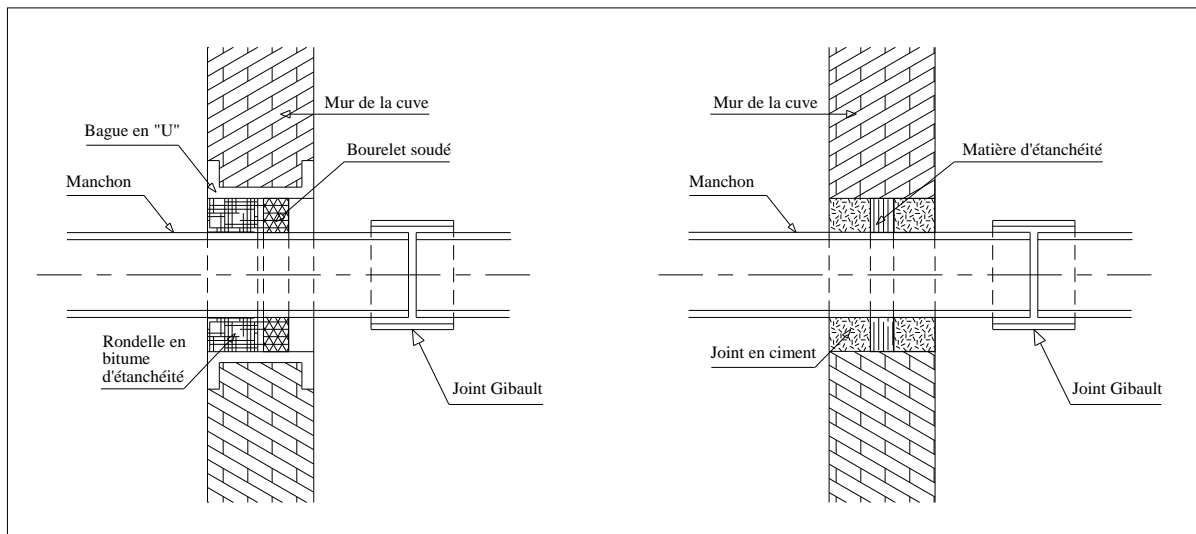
Traversée des conduites (manchon à bout lisse)
